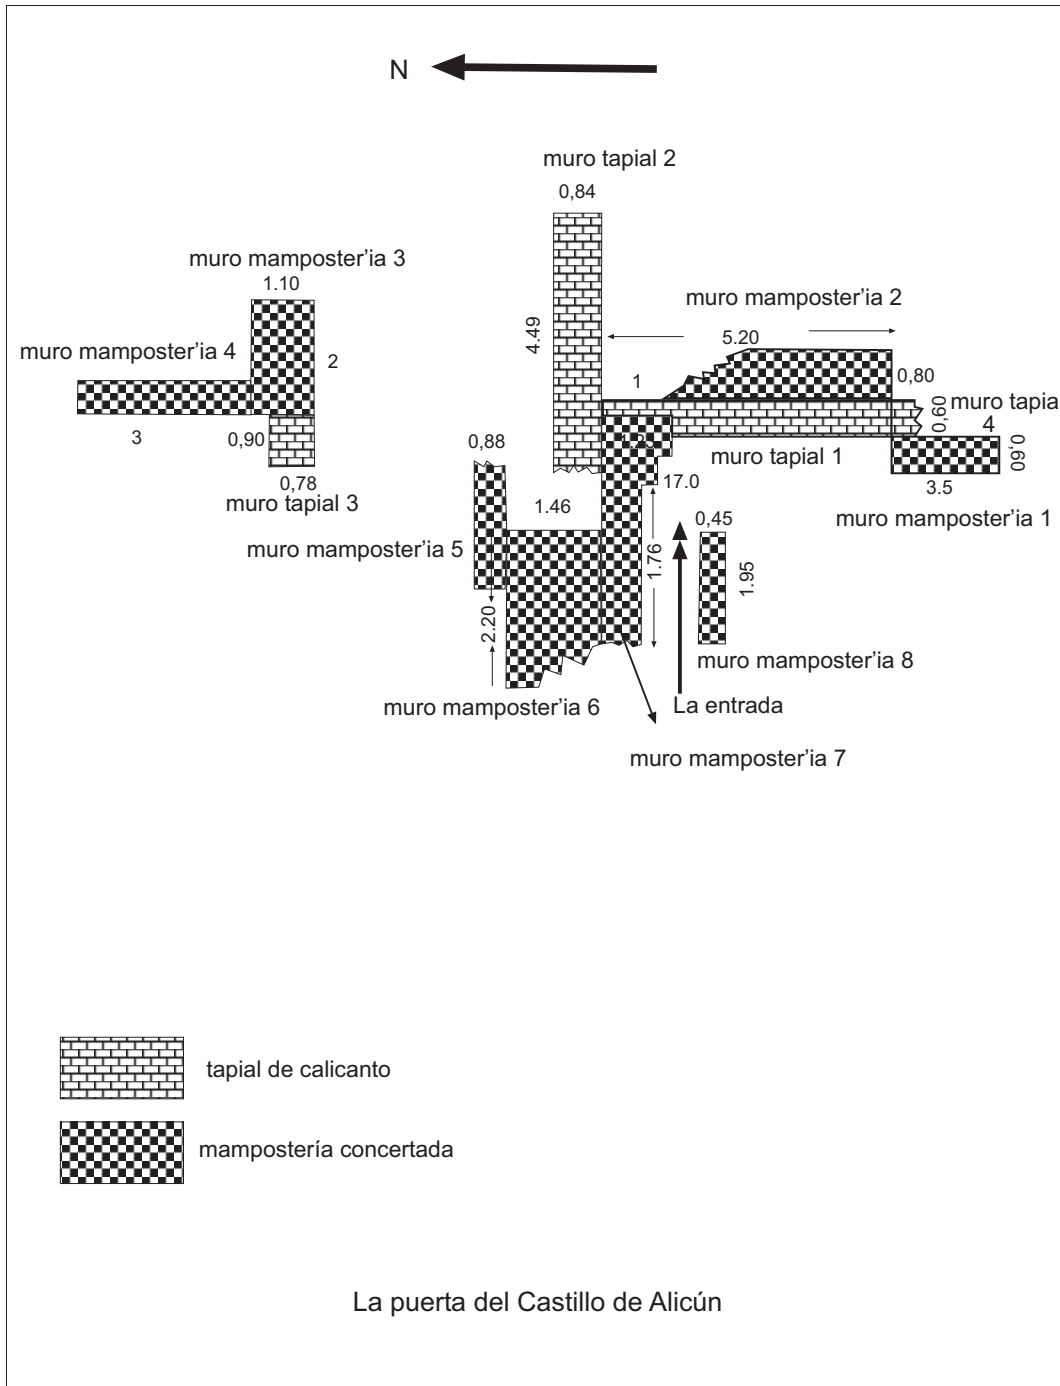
Planta simple de la puerta del castillo de Alicún con sus técnica constructivas.
